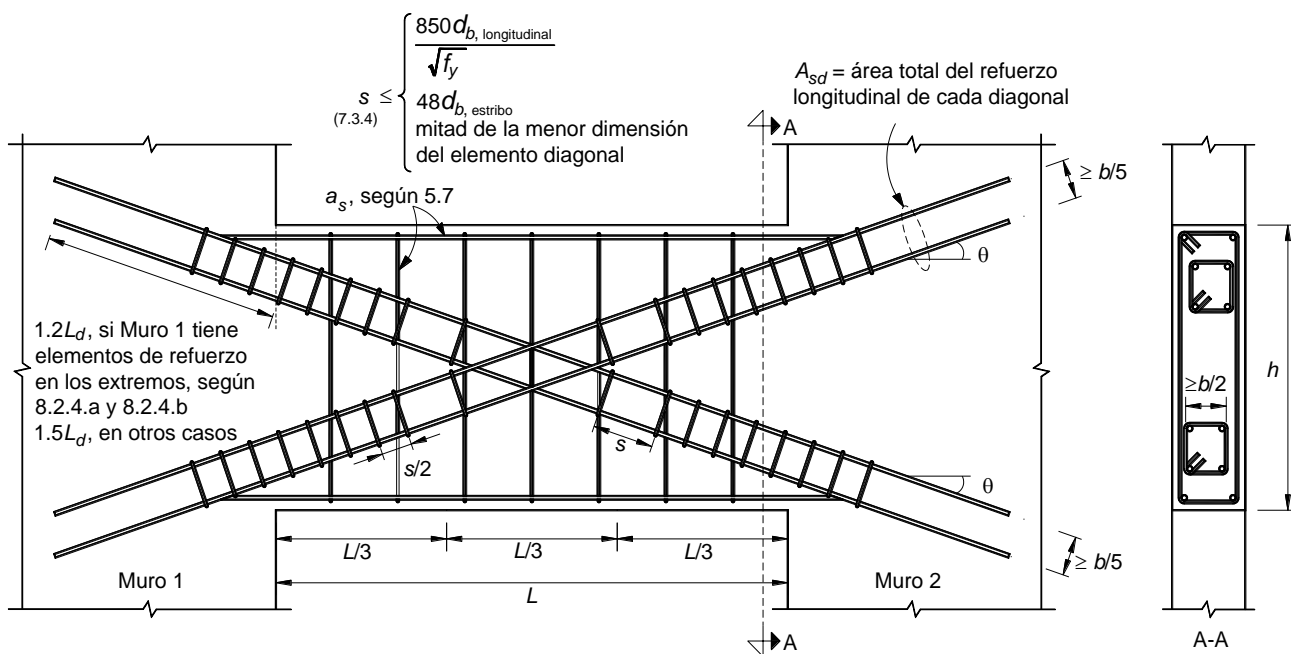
Refuerzo de una viga de gran peralte que une muros sujetos a fuerzas horizontales en su plano
